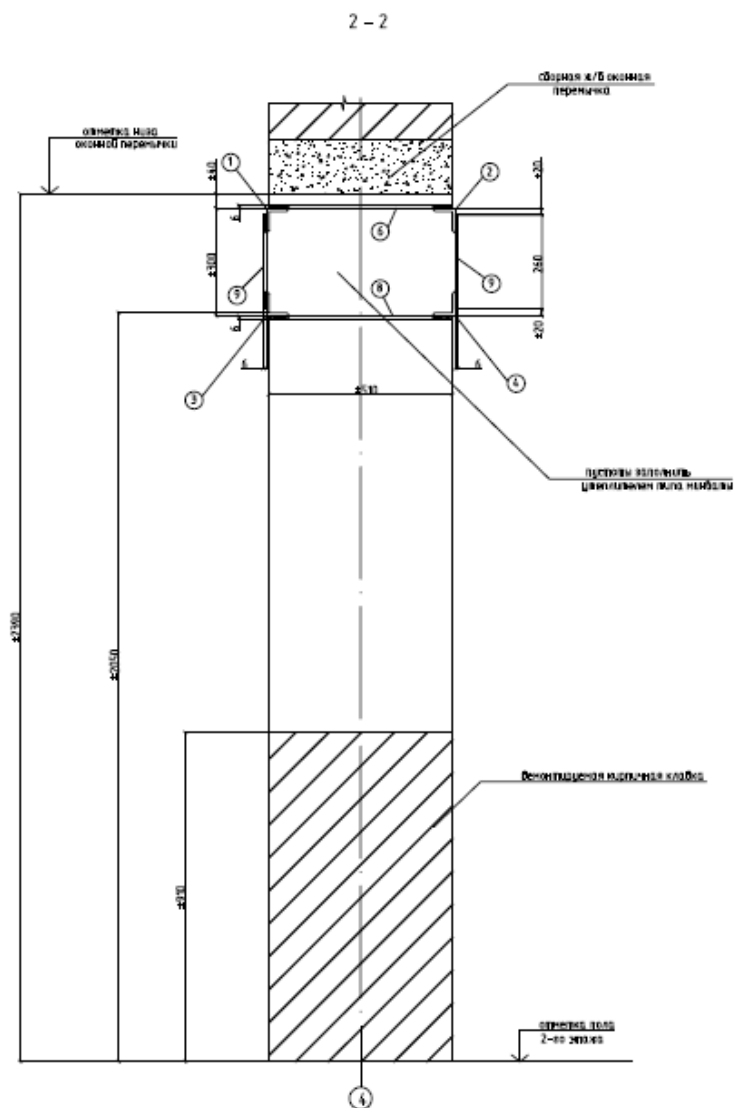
Установка решетчатой перемычки под существующими сборными
